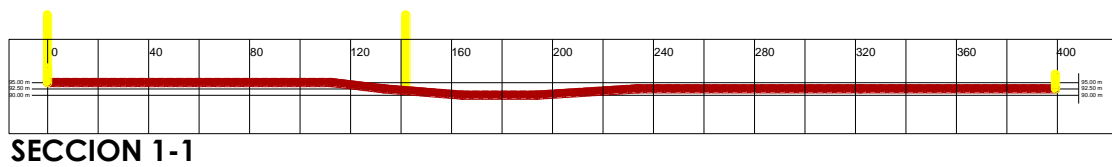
SECCION LONGITUDINAL DE PLANO TOPOGRÁFICO (fuente: Propia)
